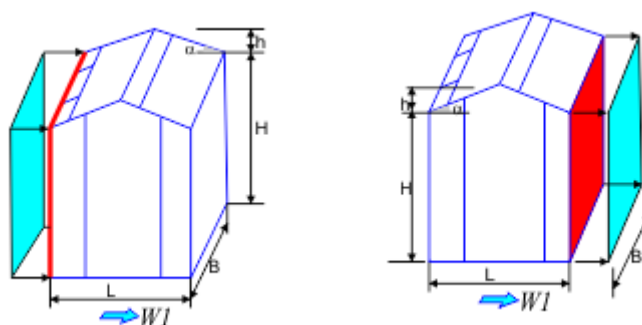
Схема приложения ветровой нагрузки на боковые стены
